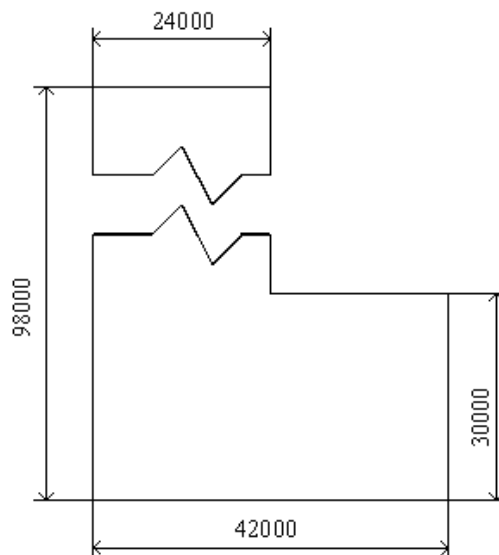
План помещения невыпуклой формы к задаче 1.3.15
